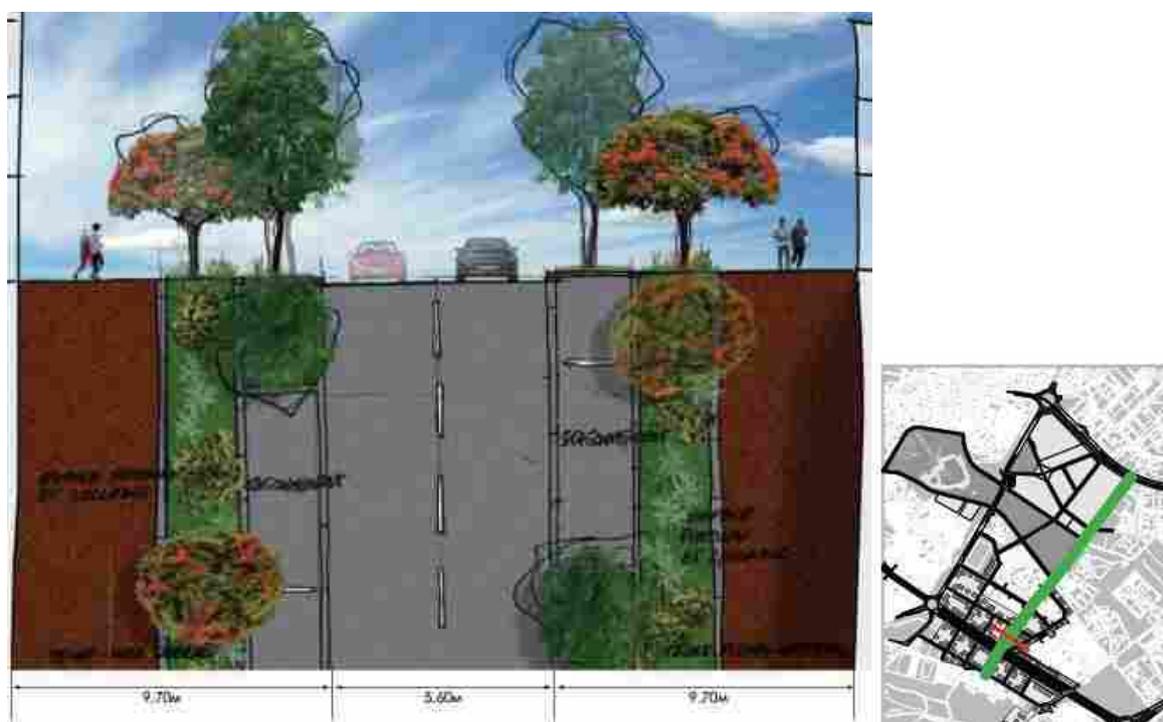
Profil en travers proposé au droit de la future voie structurante
